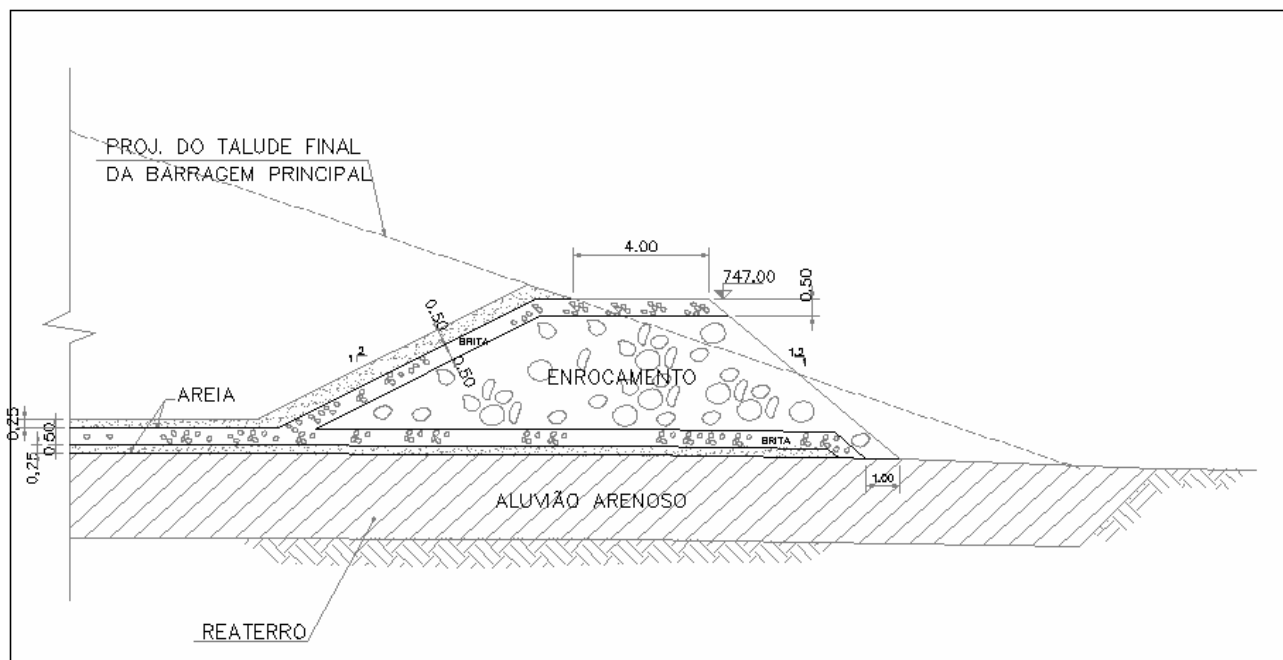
detalhe do dreno de pé da configuração final da barragem.
